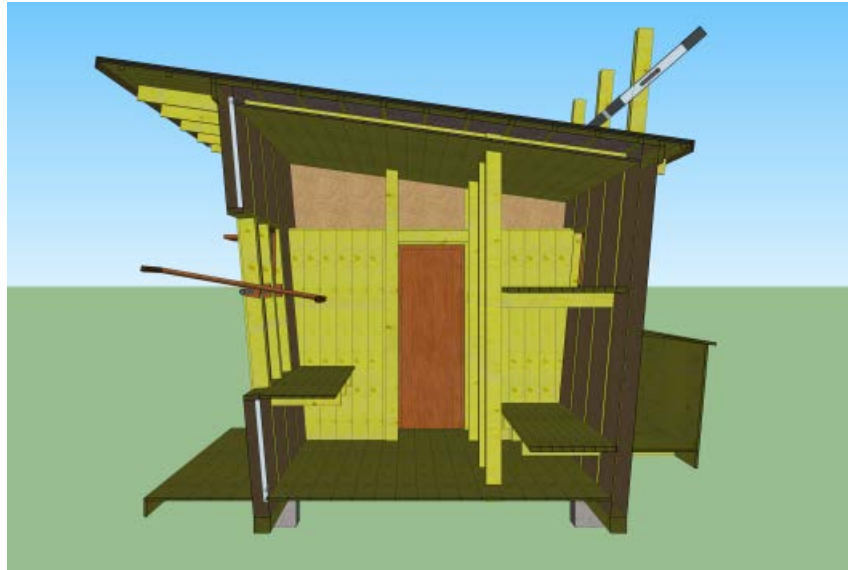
Módulo de emergencia proyectado en madera y tierra por PILIKO (Fuente: PILIKO)
